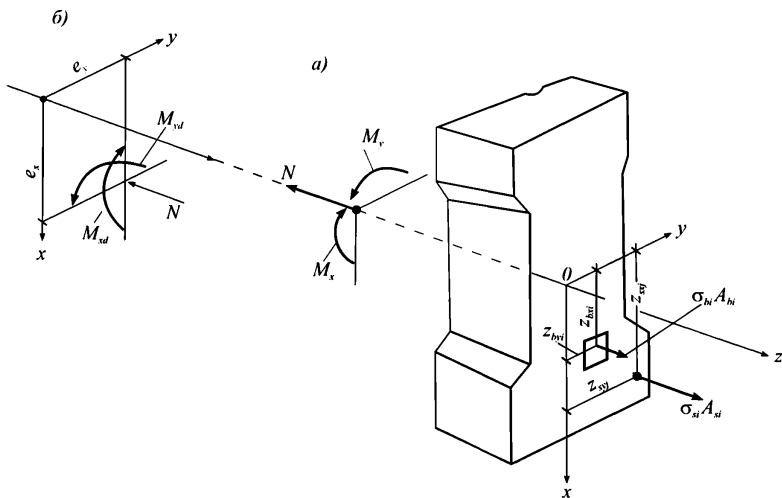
Расчетная схема нормального сечения железобетонного элемента
